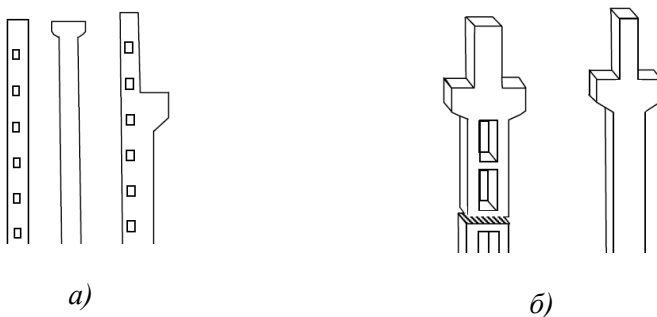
Колонны: а – колонны квадратного сечения; б – двухветвевые колонны прямоугольного сечения
